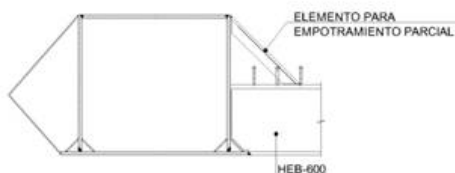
Detalle del empotramiento parcial de las vigas transversales en la viga longitudinal
